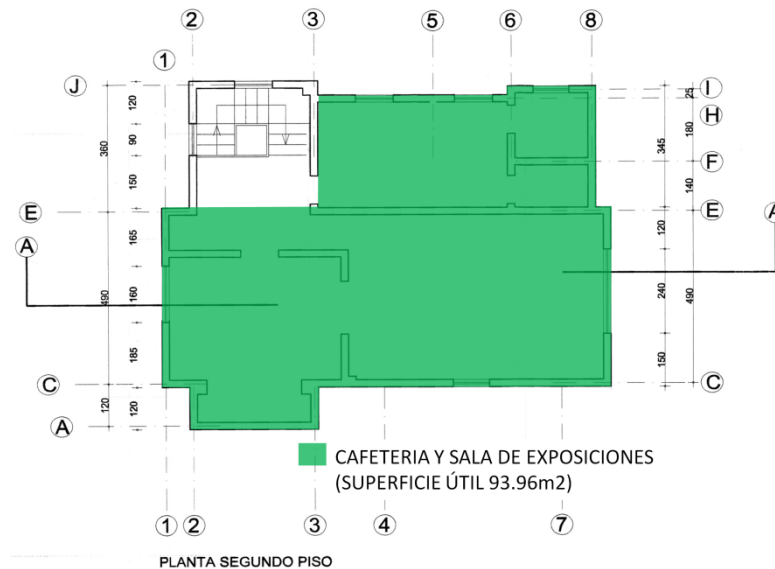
Planta Segundo Piso Casona Ex Sporting
